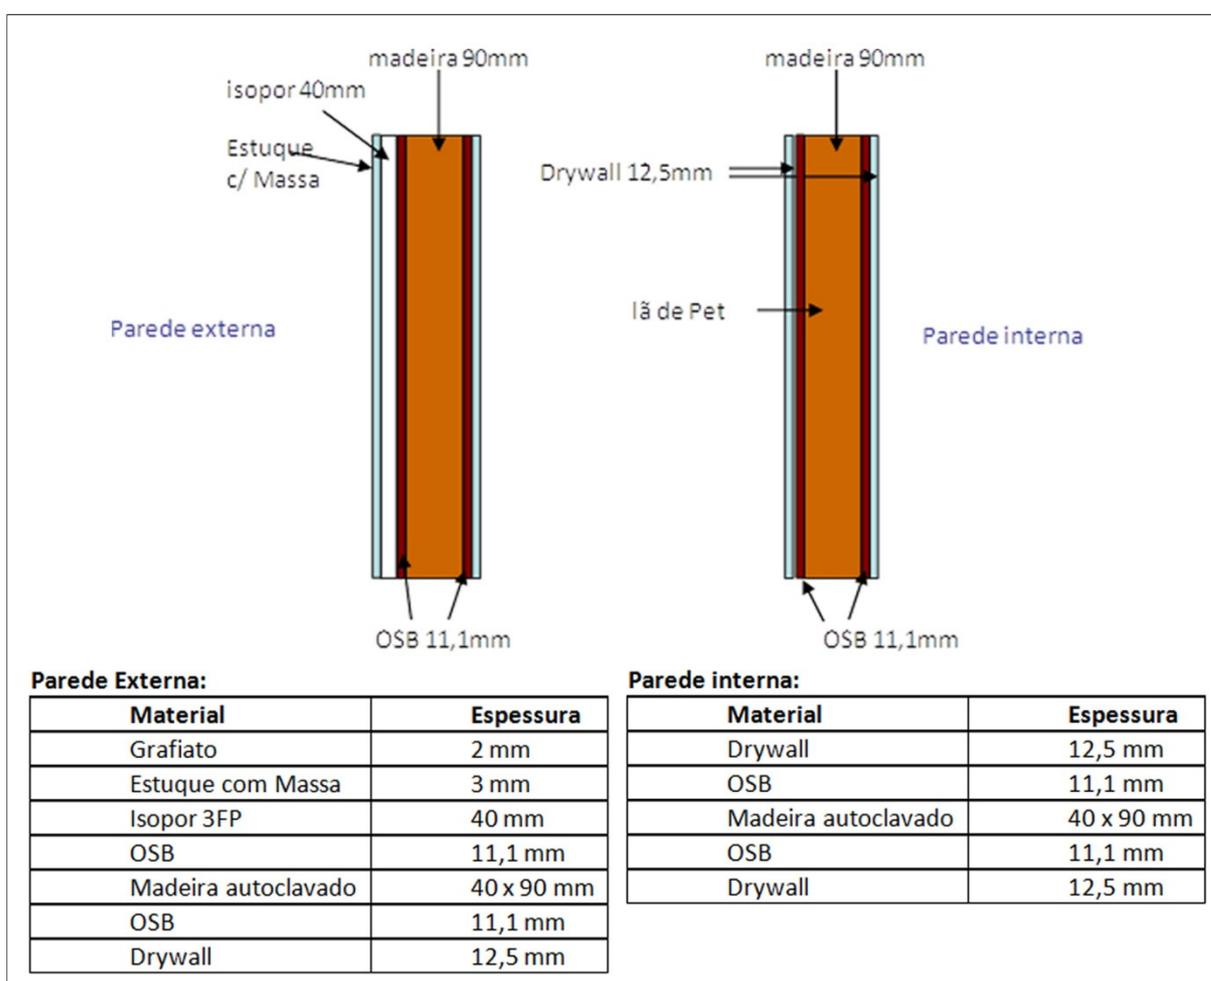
Composição da parede no sistema Wood Frame da Empresa 1
